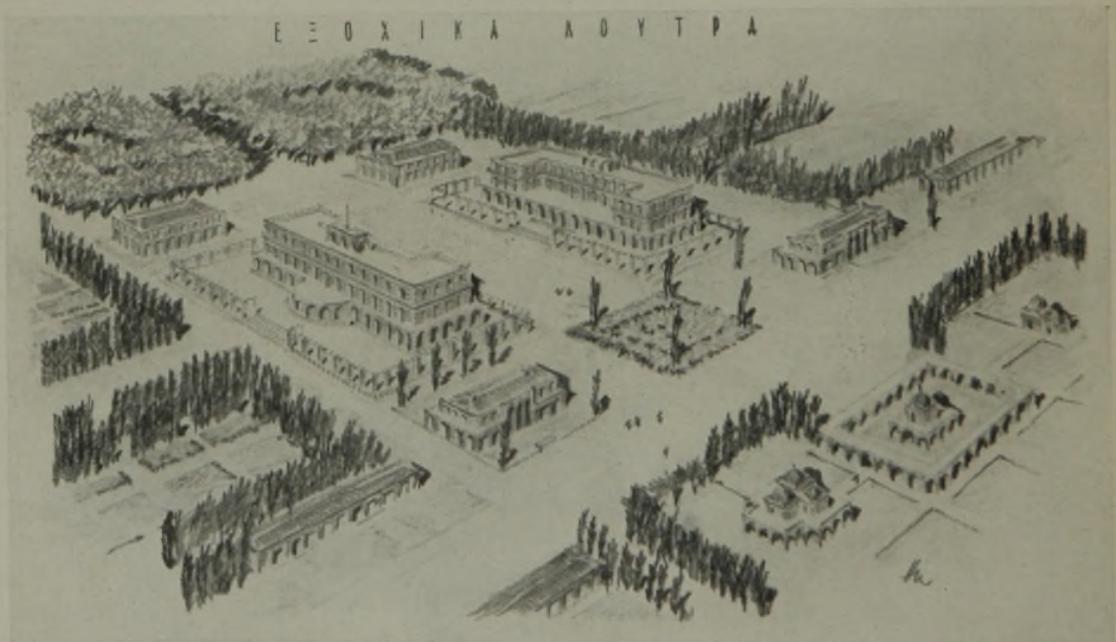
Anlage eines Badeortes in der Nähe einer Hafenstadt. Bebauung mit Hotels, Badepavillons, Wohnhäusern, Autogaragen und Restaurants.
